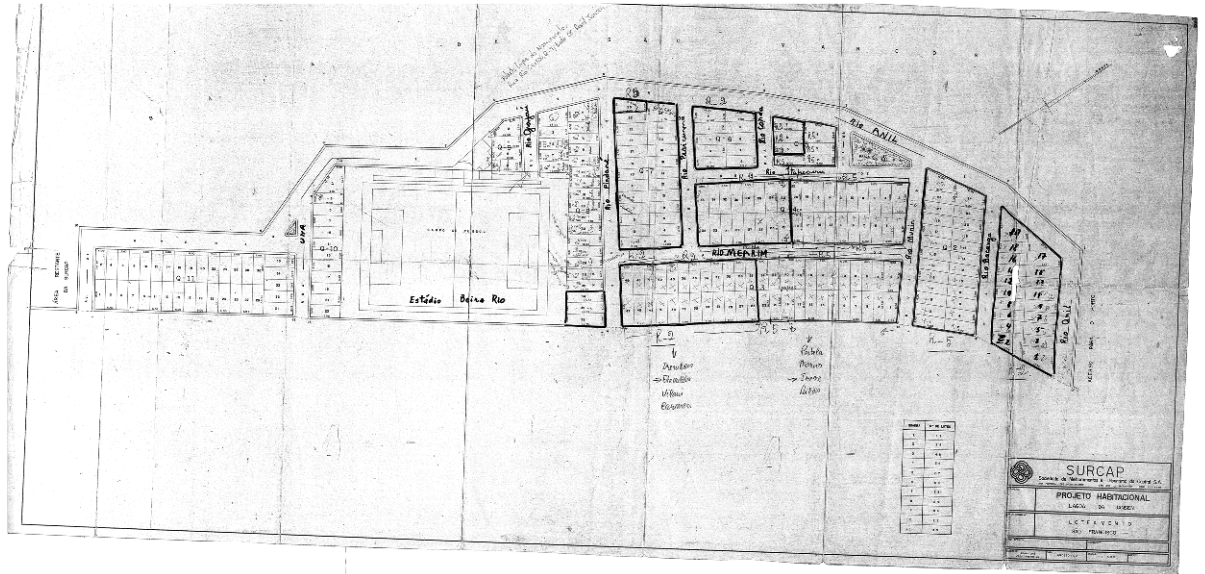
Plano original de implantação do Residencial Ana Jansen
